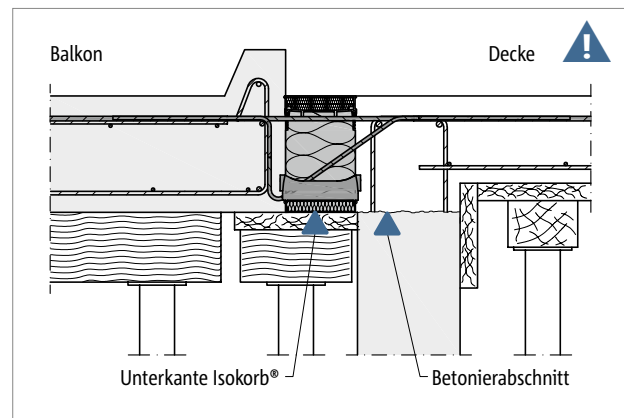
Schöck Isokorb® XT Typ K: Vollfertigteilbalkon mit höhenversetzter Decke auf vorgefertigter Stahlbetonwand
